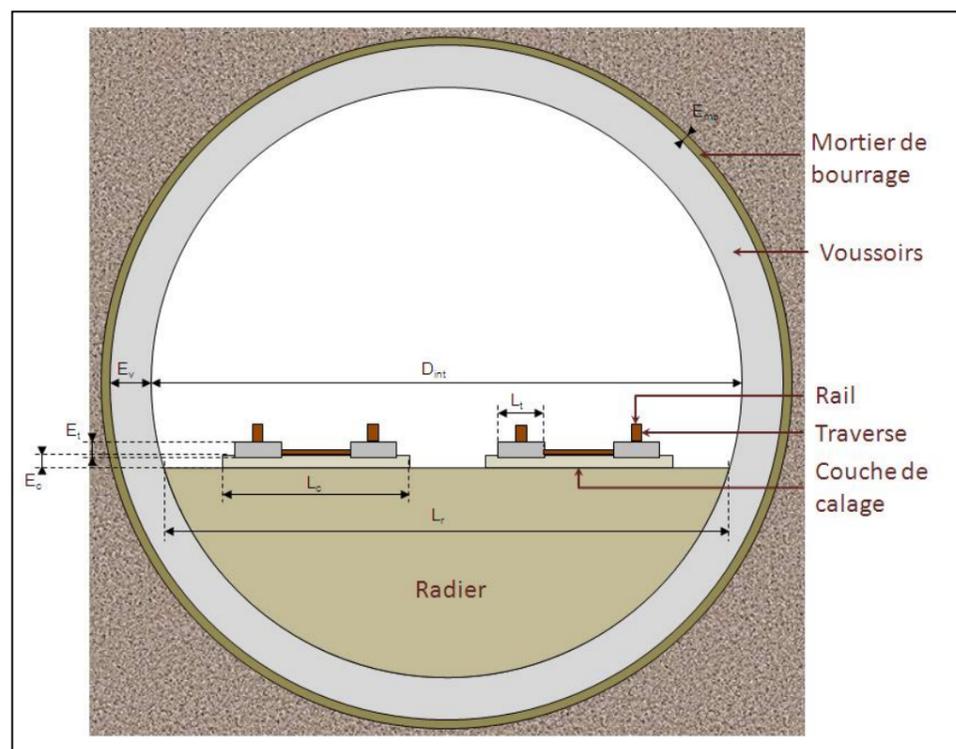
Tunnel – Schéma d'une vue en coupe et dimensions prises en compte dans l'outil
